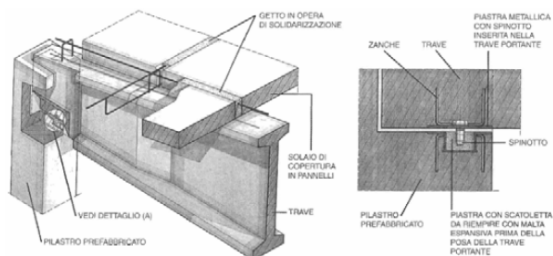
Collegamento trave-pilastro a doppia pendenza
